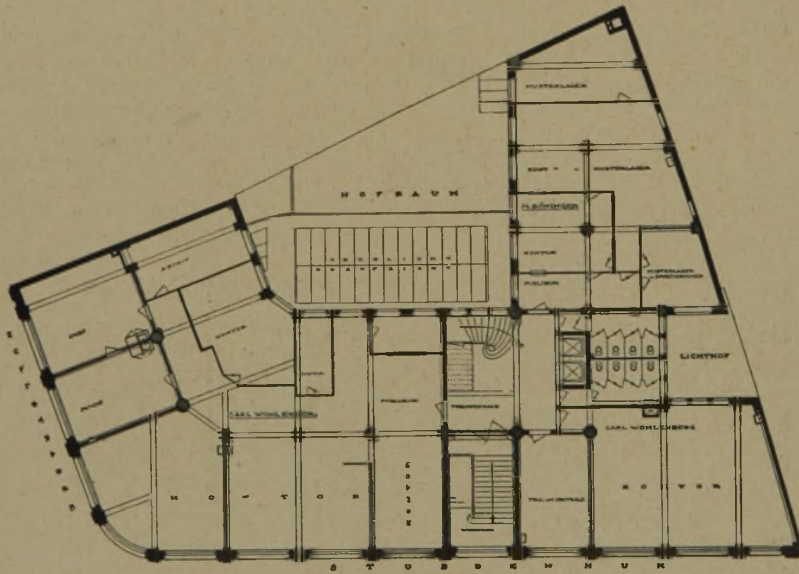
Grundriß des Erdgeschosses. (1:400.)
